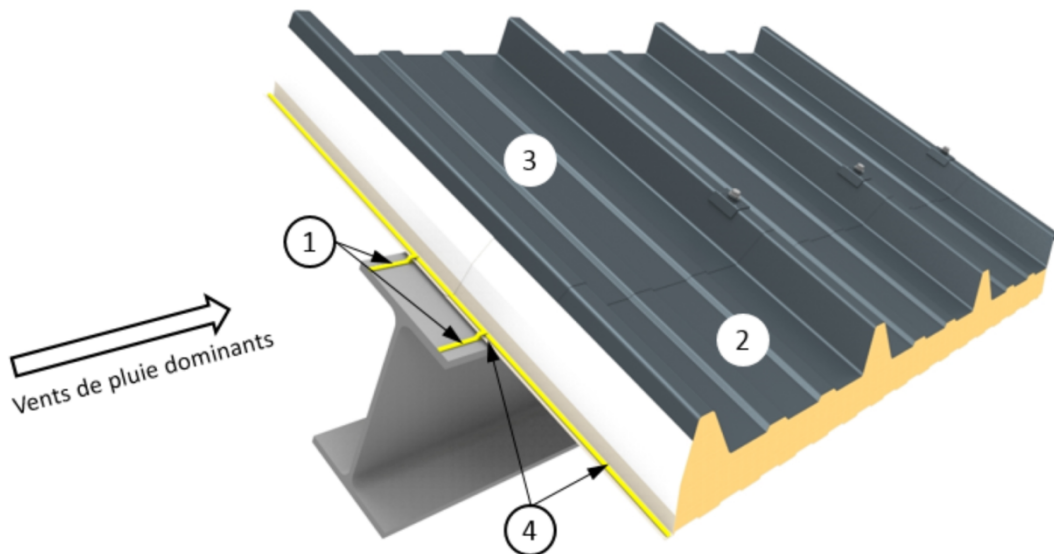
Détail sur appui – Joints sur appuis au droit d'un recouvrement transversal de panneaux sans complément d'étanchéité (CE) – locaux climatisés (cf. §2.4.4)
